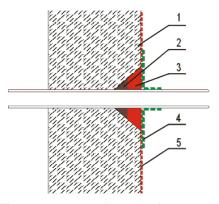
Прохождение трубы через бетон «на жестко» (металлическую трубу перед бетонированием нужно очистить и сделать антикоррозионную обработку, а пластмассовую трубу потереть наждачной бумагой): 1-бетонная стена, 2-пломба с Hygrostop-Fix, если во время уплотнения выплывает вода, 3-клин с Нуgrostop-Водонепроницаемого раствора, 4-гидроизоляционное покрытие с Hygrostop-Эластичного Армированного, 5-минеральное, проникающее покрытие Hygrostop.
